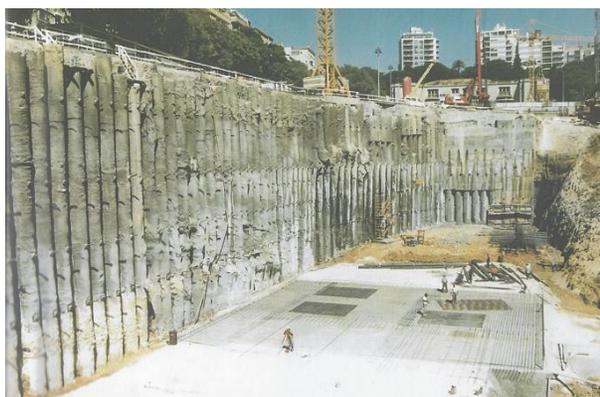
Vista da Estação Alameda do ML, após a conclusão da escavação.
